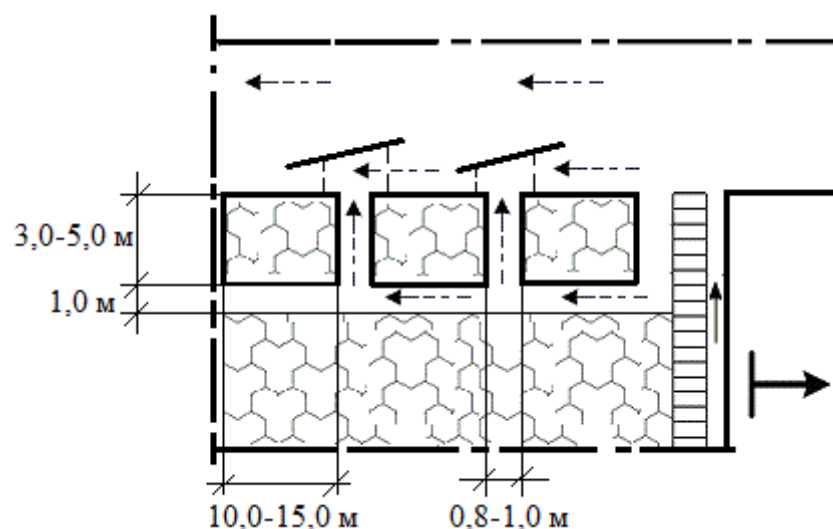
Схема продольных и поперечных каналов в буттовых полосах под вентиляционным штреком с камерами смешивания на штреке
